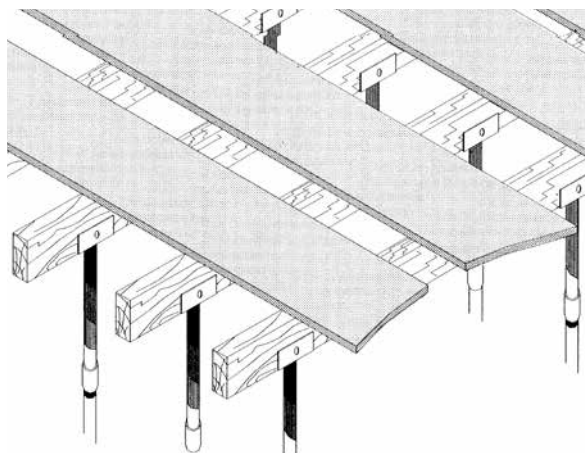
Pose et mise à niveau des planches ou bastaings
